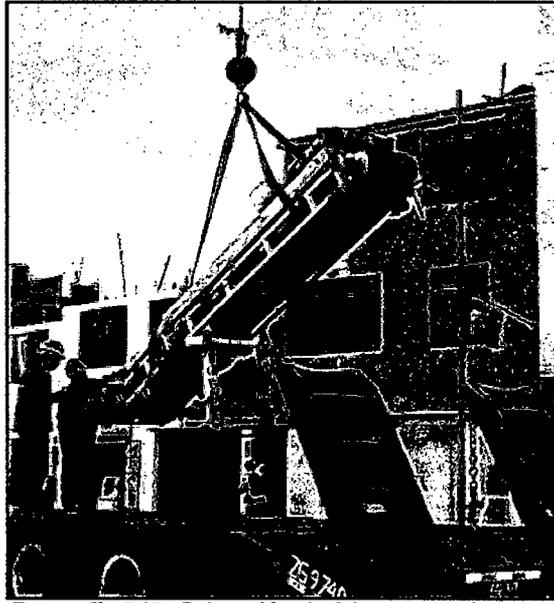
Colocación de Shield sobre la cama baja.
